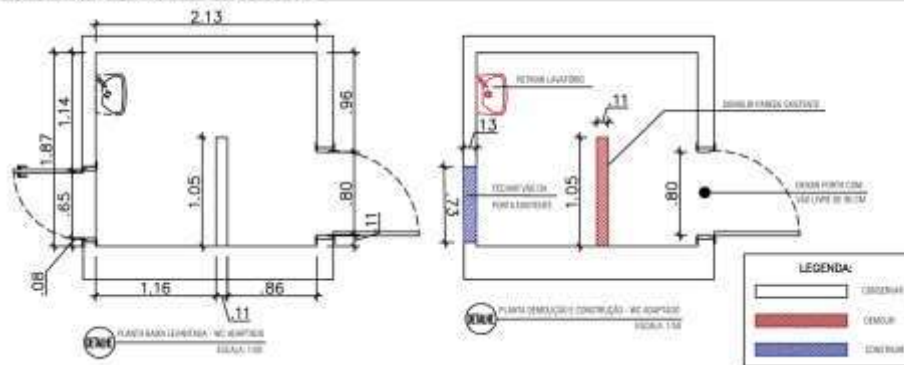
planta de reforma para adaptação do banheiro PNE (sem escala)
